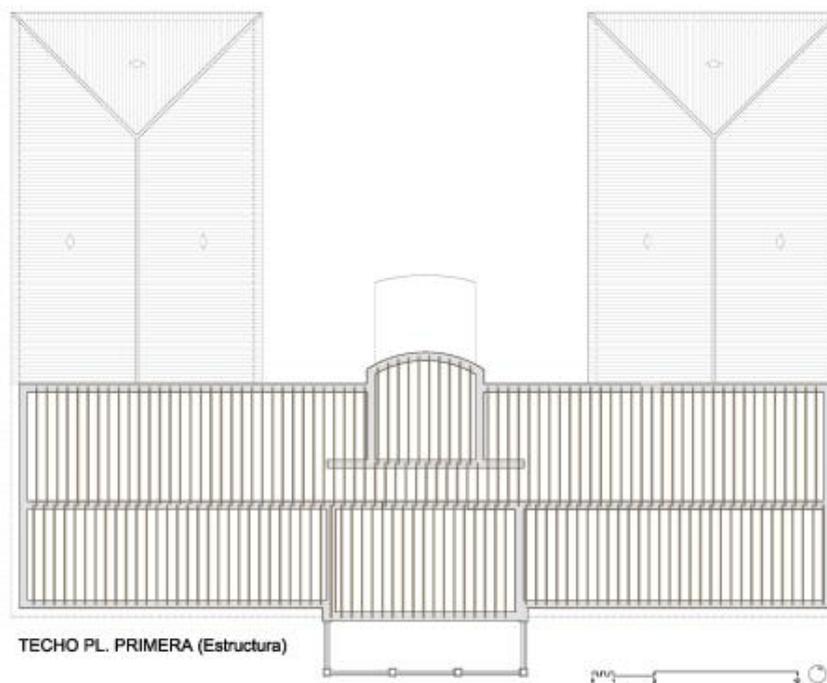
Esquema estructural de planta primera. Orenes García, Matías J., 2015.
